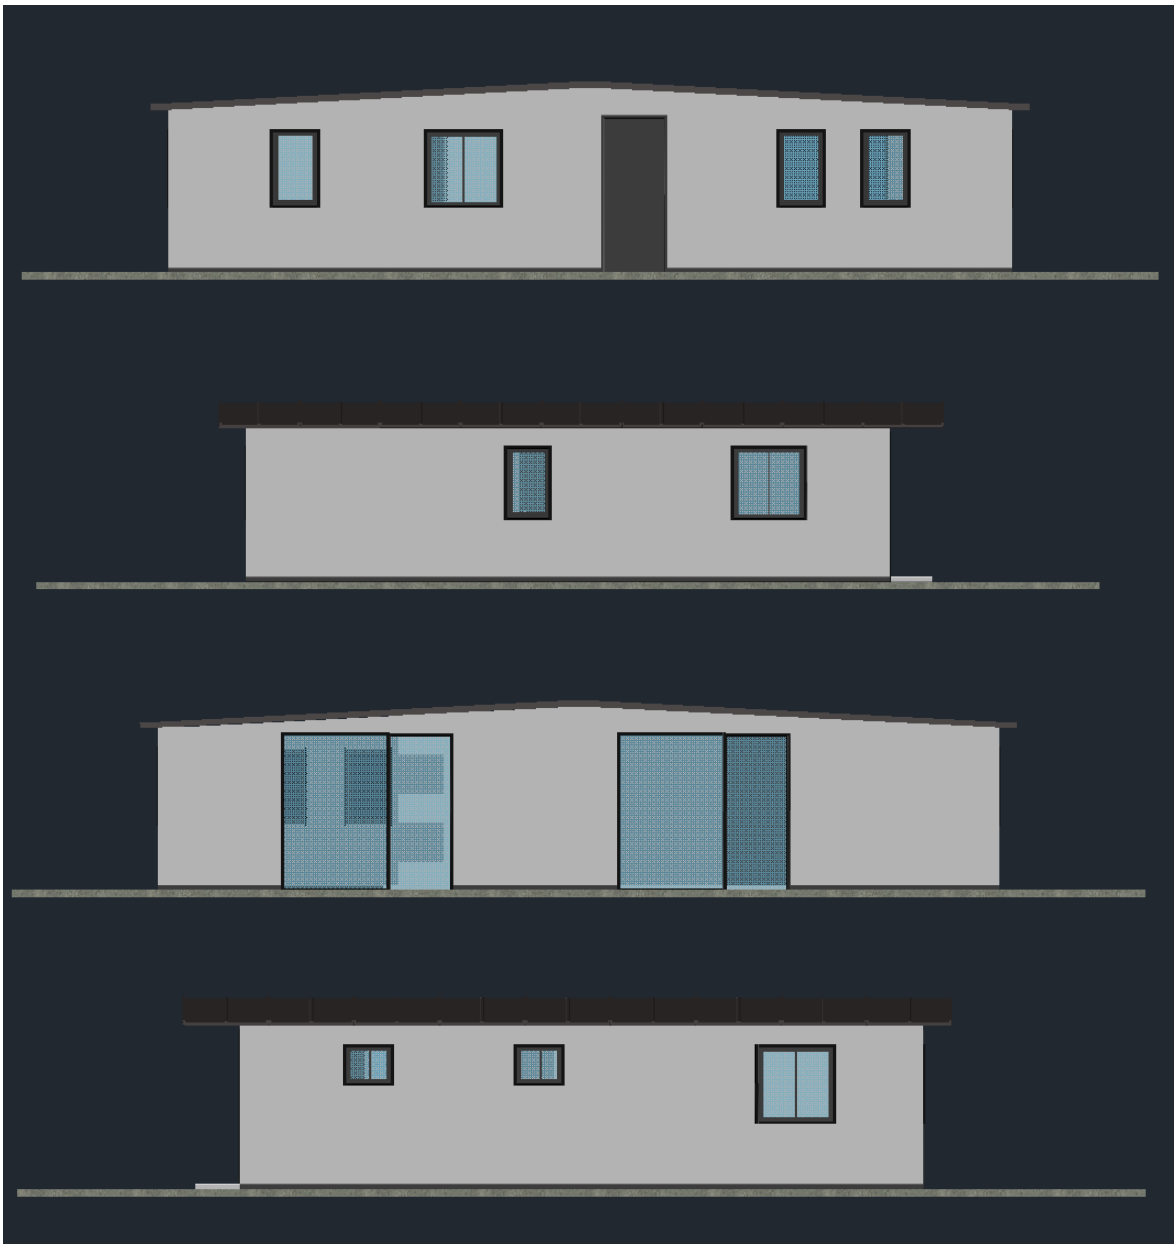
Alzado frontal, alzado derecho, alzado posterior y alzado izquierdo.
